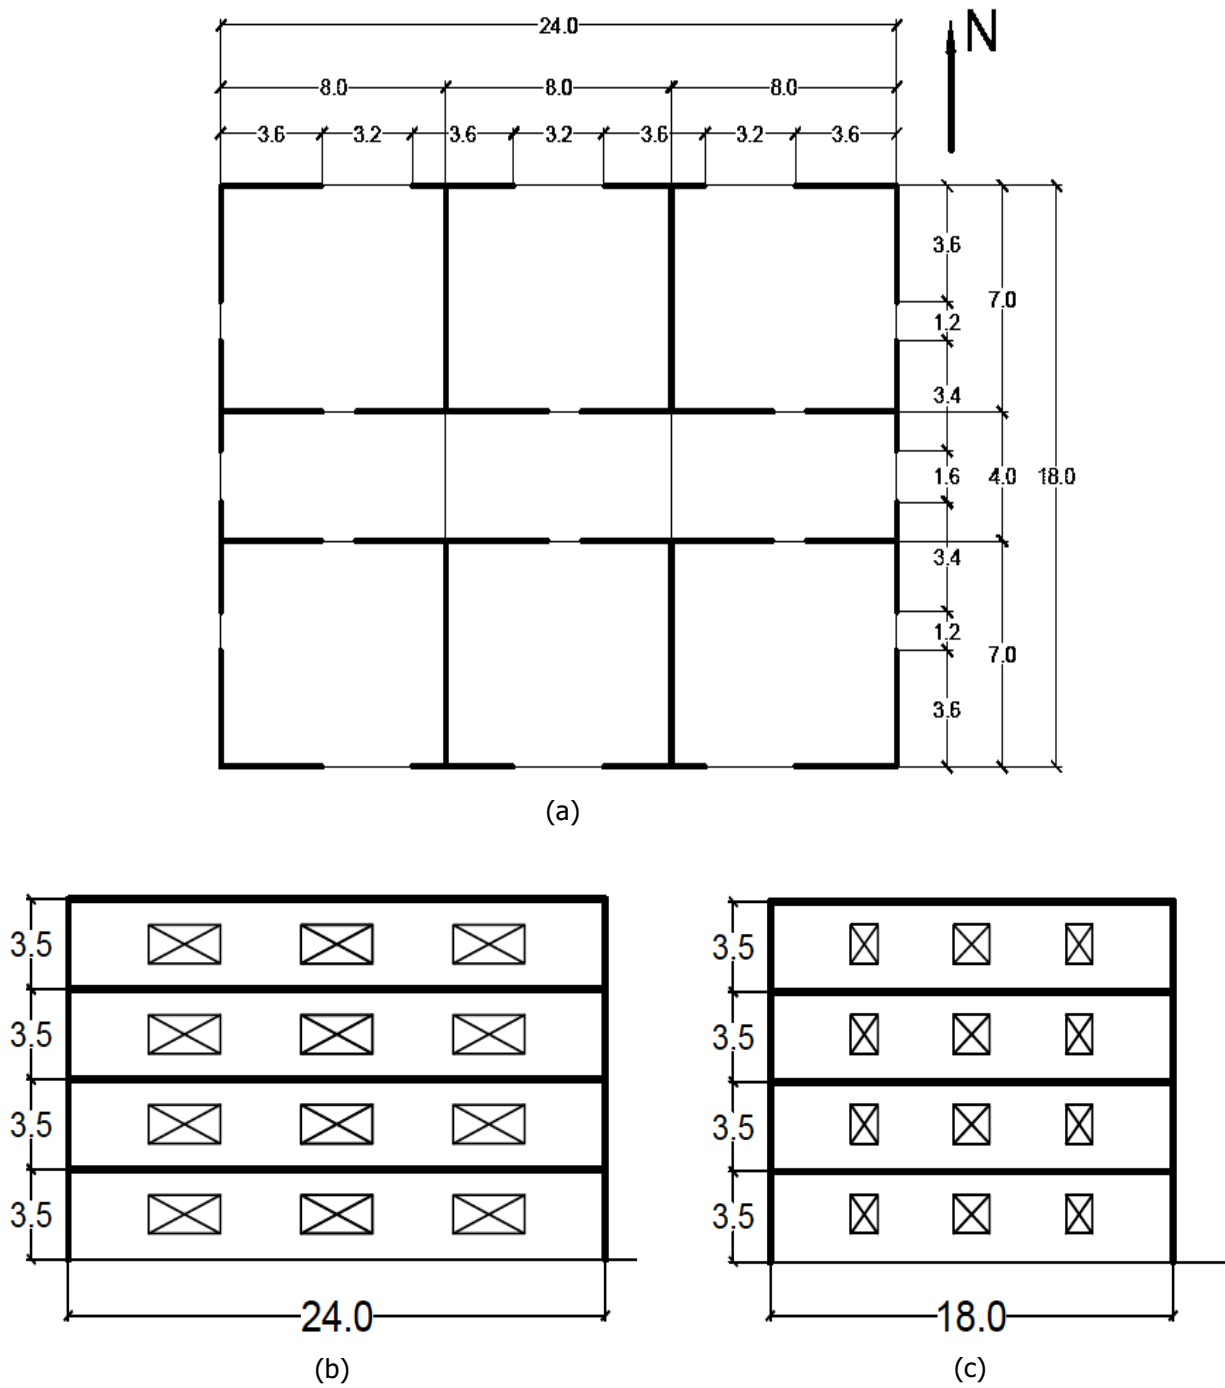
Dimensiones en planta (a) y elevación (b y c) de las edificaciones (cotas en m)
